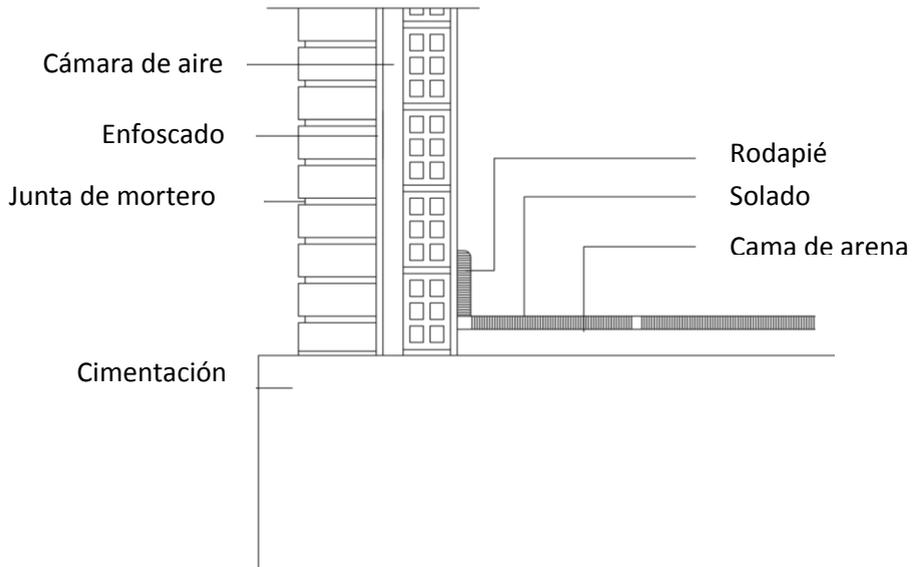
Detalle constructivo de arranque de fachada. Fuente propia 2014.
